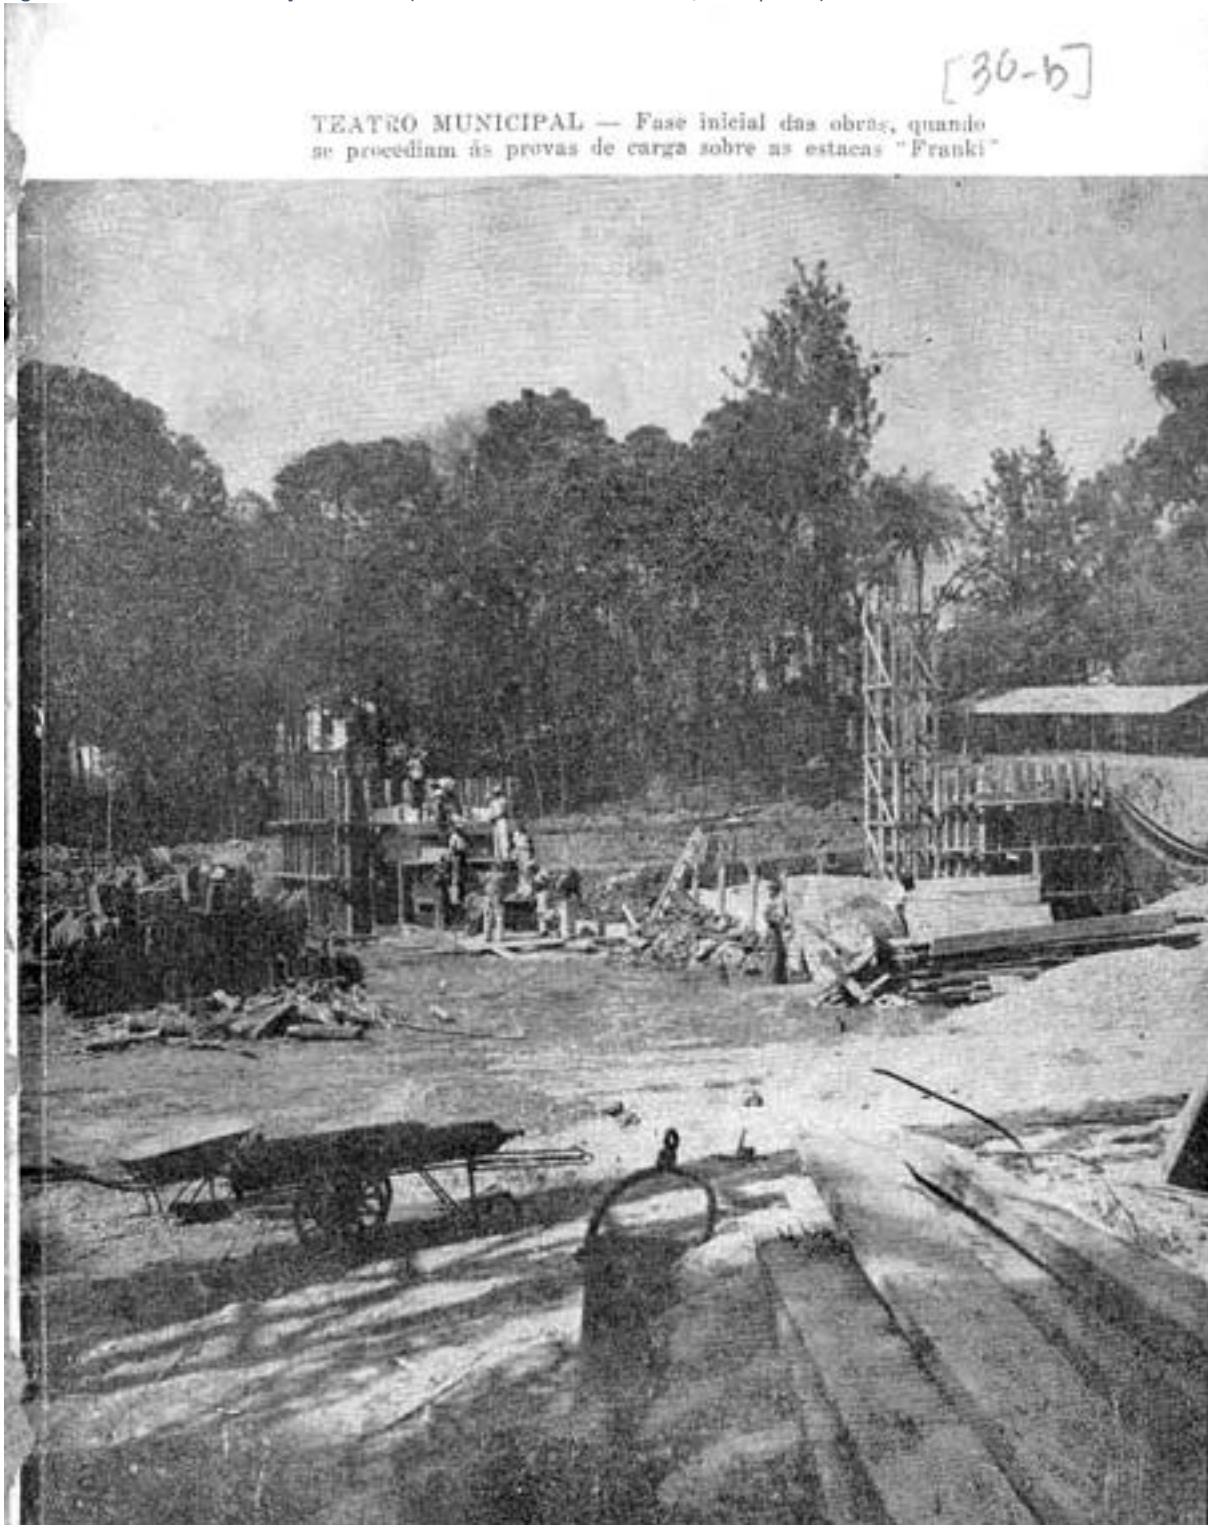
foto da construção – fonte: Oscar Niemeyer Works (12) Facebook
